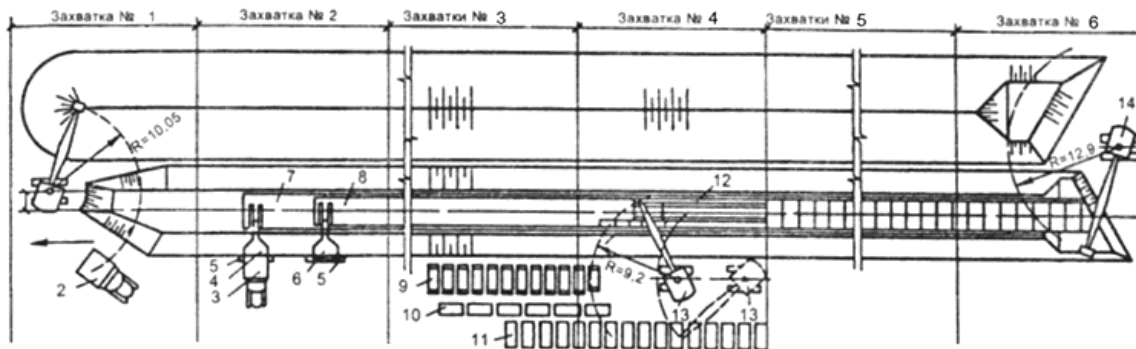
Технологическая схема монтажа сборного железобетонного тоннеля
